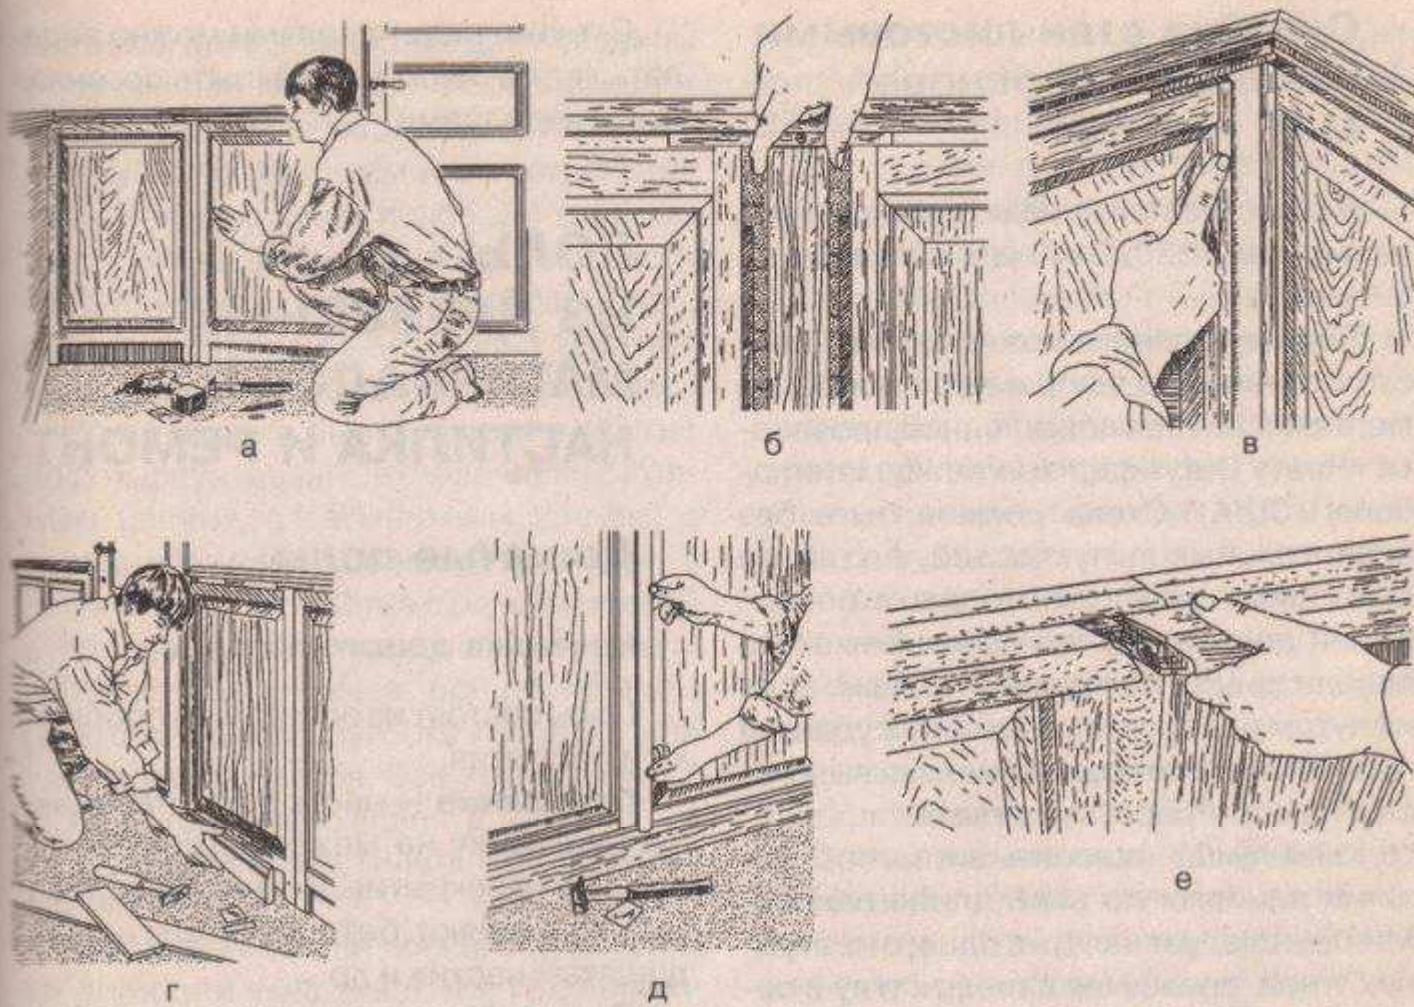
Монтаж филенчатых панелей: а — установка панелей; б — установка наращивающих накладок; в — оформление внутренних углов; г — установка плинтуса; д — закрытие стыков специальными планками; е — установка бордюра
